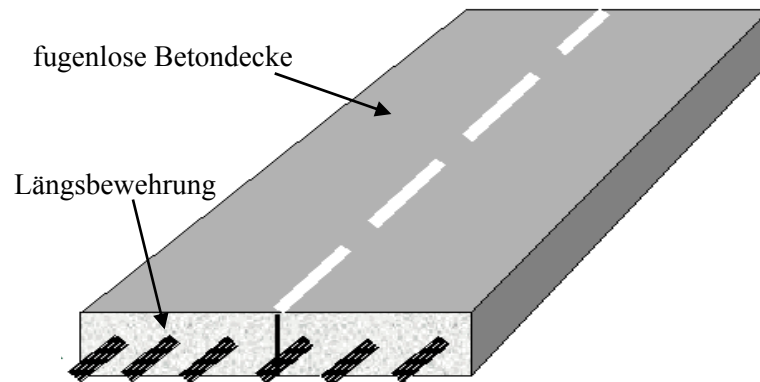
Schemaskizze einer durchgehend bewehrten Betondecke /3/
